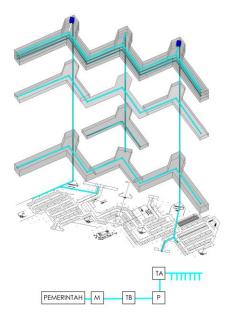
Sambungan lantai dengan lantai (biru)
